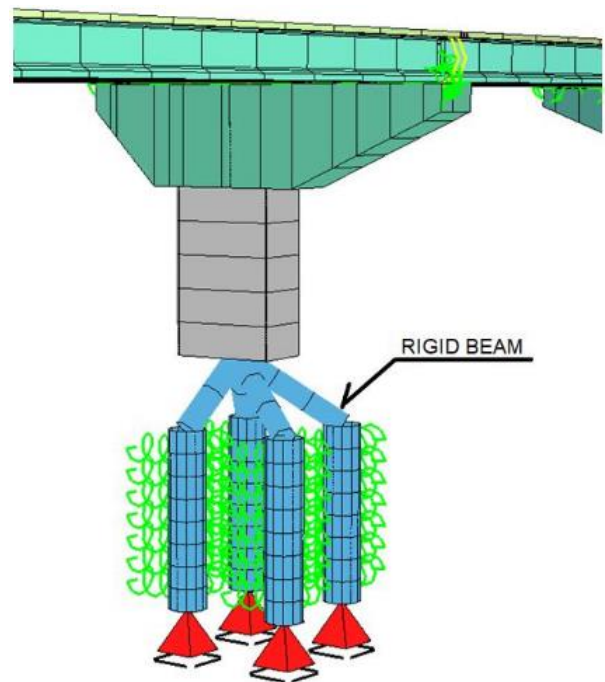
Modelo conjunto de superestructura, pila, y encepado con pilotes.
